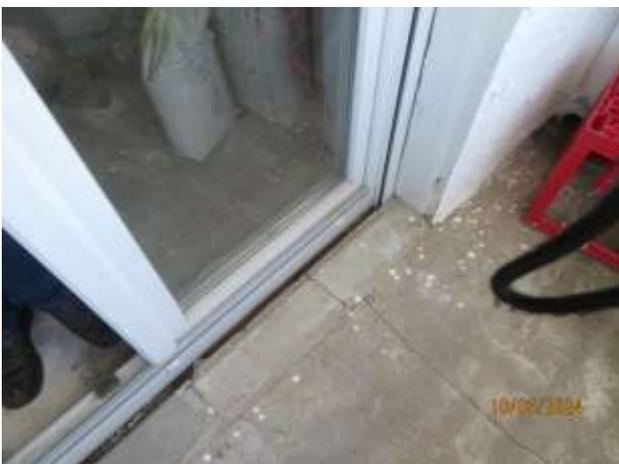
Teilansicht Fertigstellungsbedarf nach Einbau einer Balkontür
